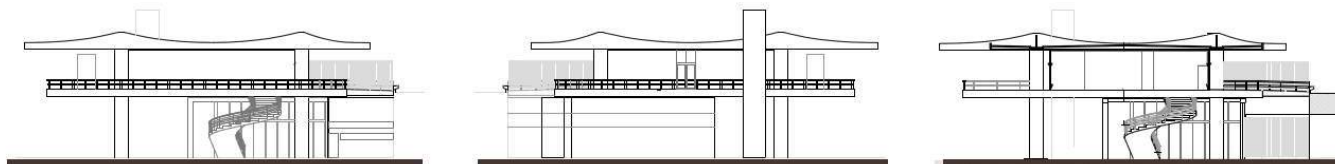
Fachadas norte, sul e corte. Fonte: ALBERNAZ, 2012.
